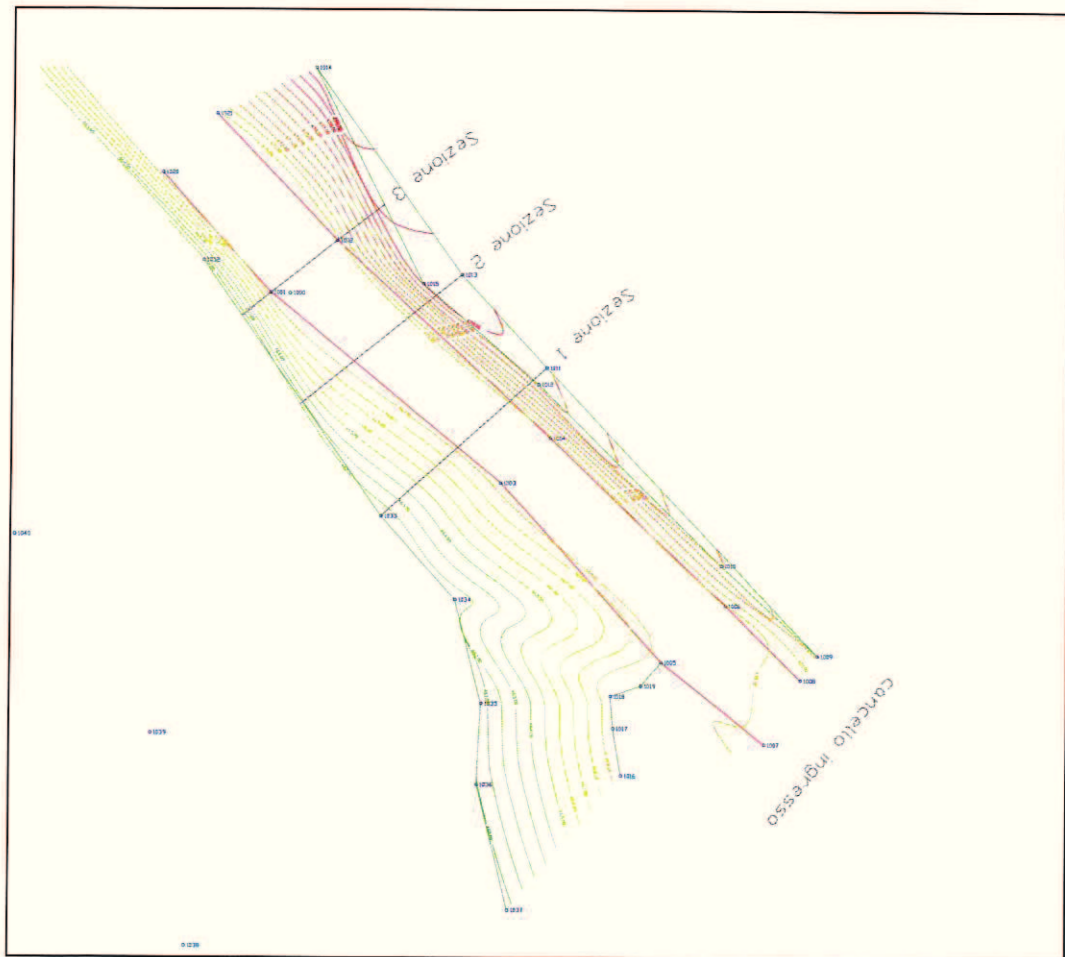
Planimetria della zona indagata con traccia delle sezioni
